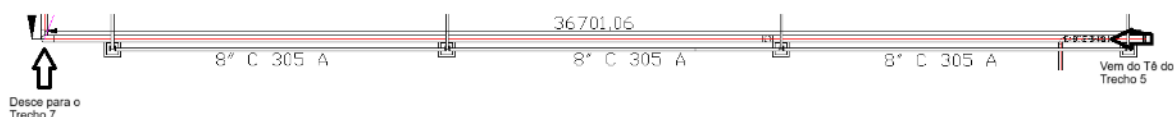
vista superior da linha de 8 polegadas acima da estrutura metálica
